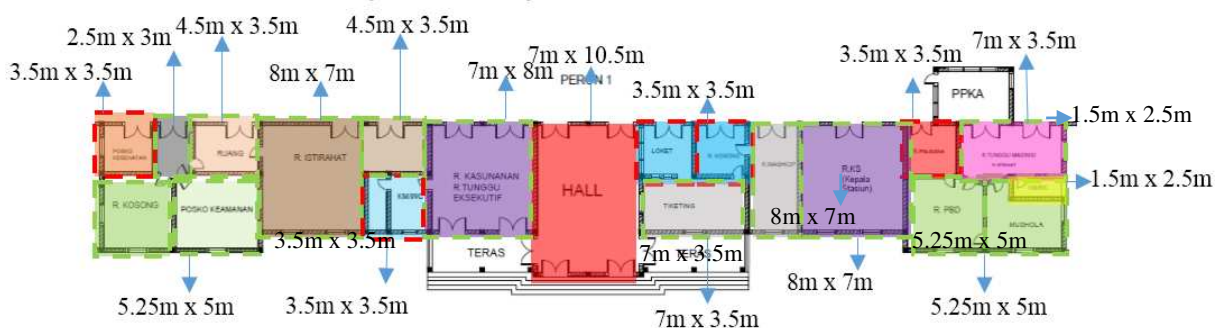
Proporsi Panjang dan Lebar pada Denah Bangunan Stasiun Solo Jebres
